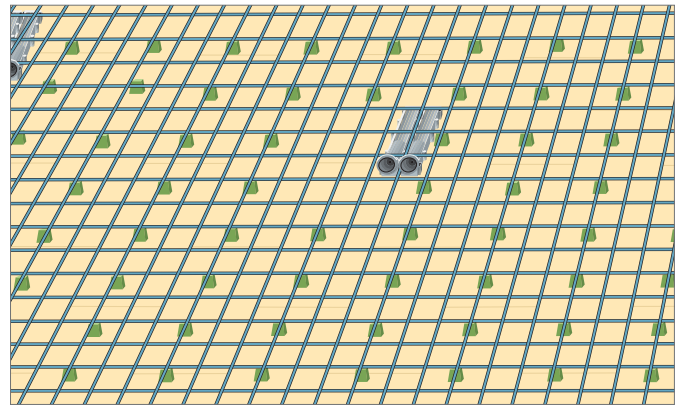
Punto 1 - Montaje de las cajas encofrado BKT
